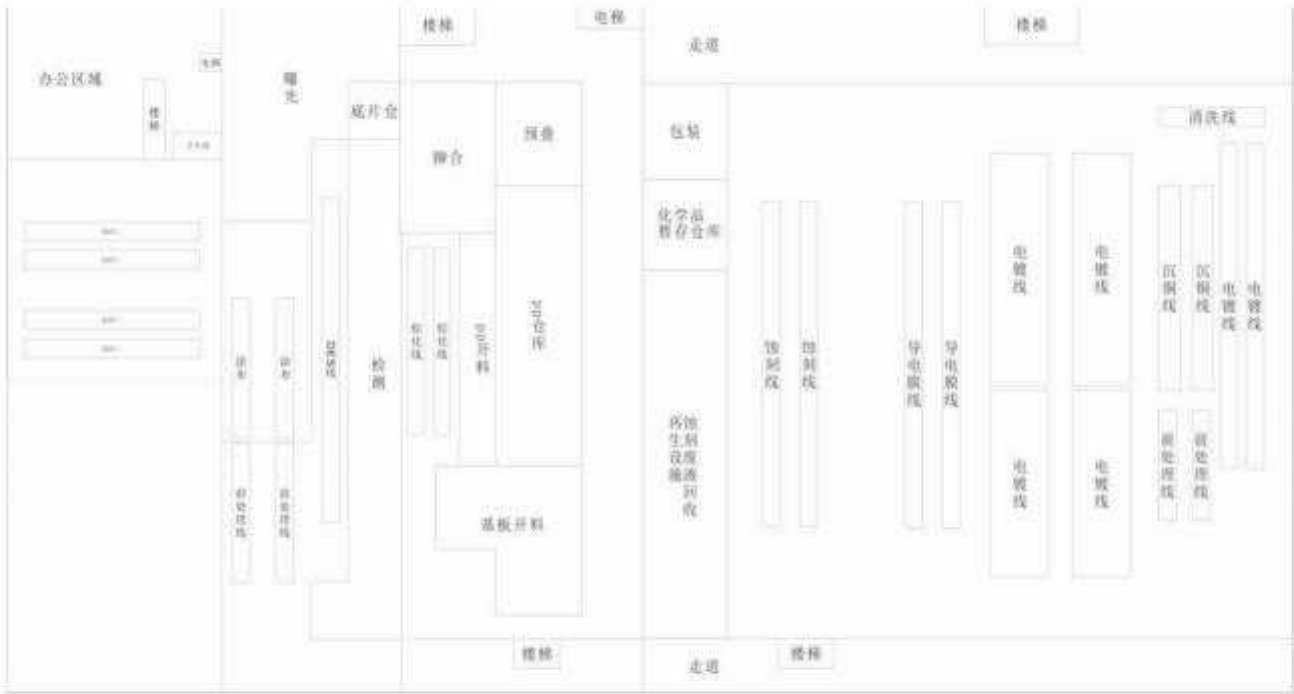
项目厂房 2.3.4 三层平面布置图
